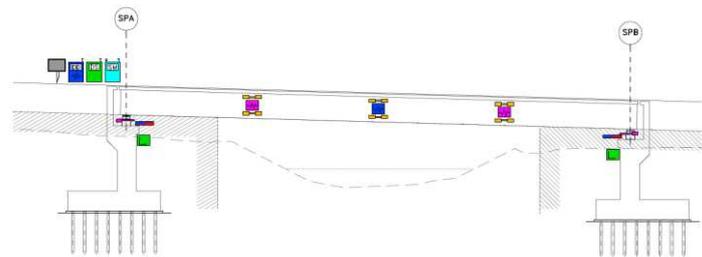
Schema profilo impalcato posizionamento strumentazione ponti
